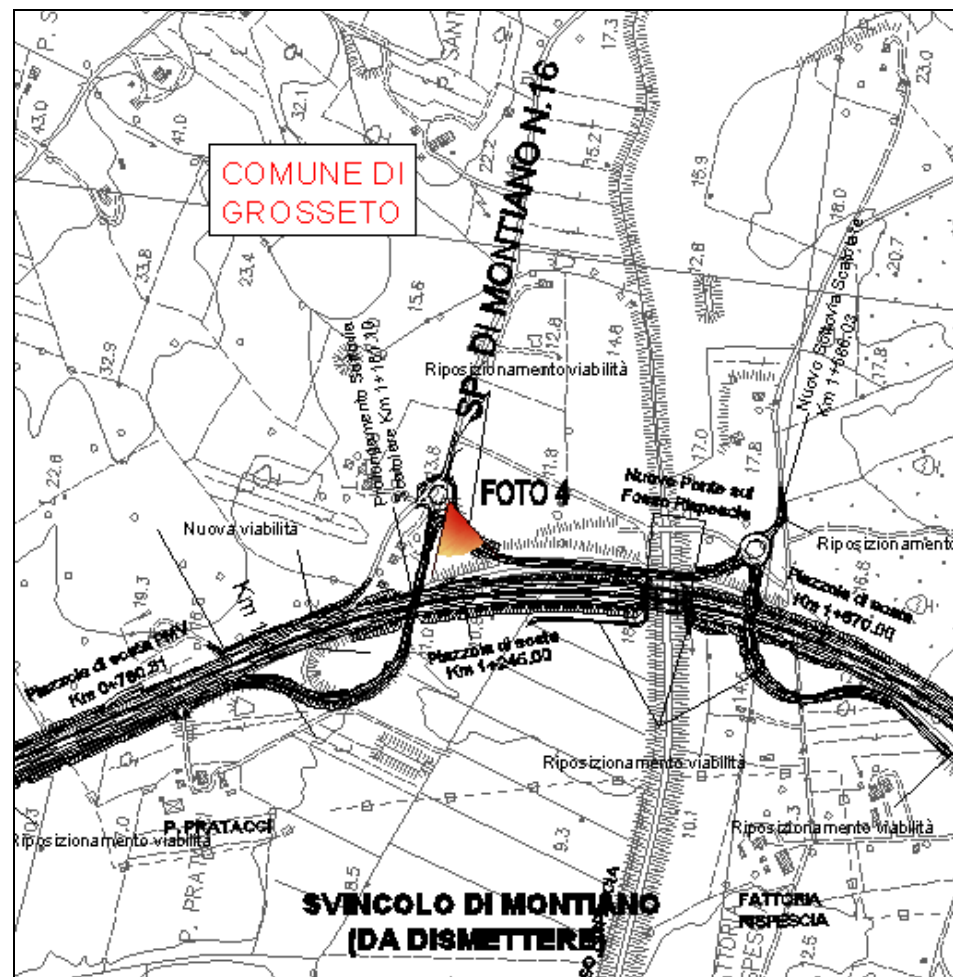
Stralcio planimetrico con individuazione dei punti di ripresa delle foto
